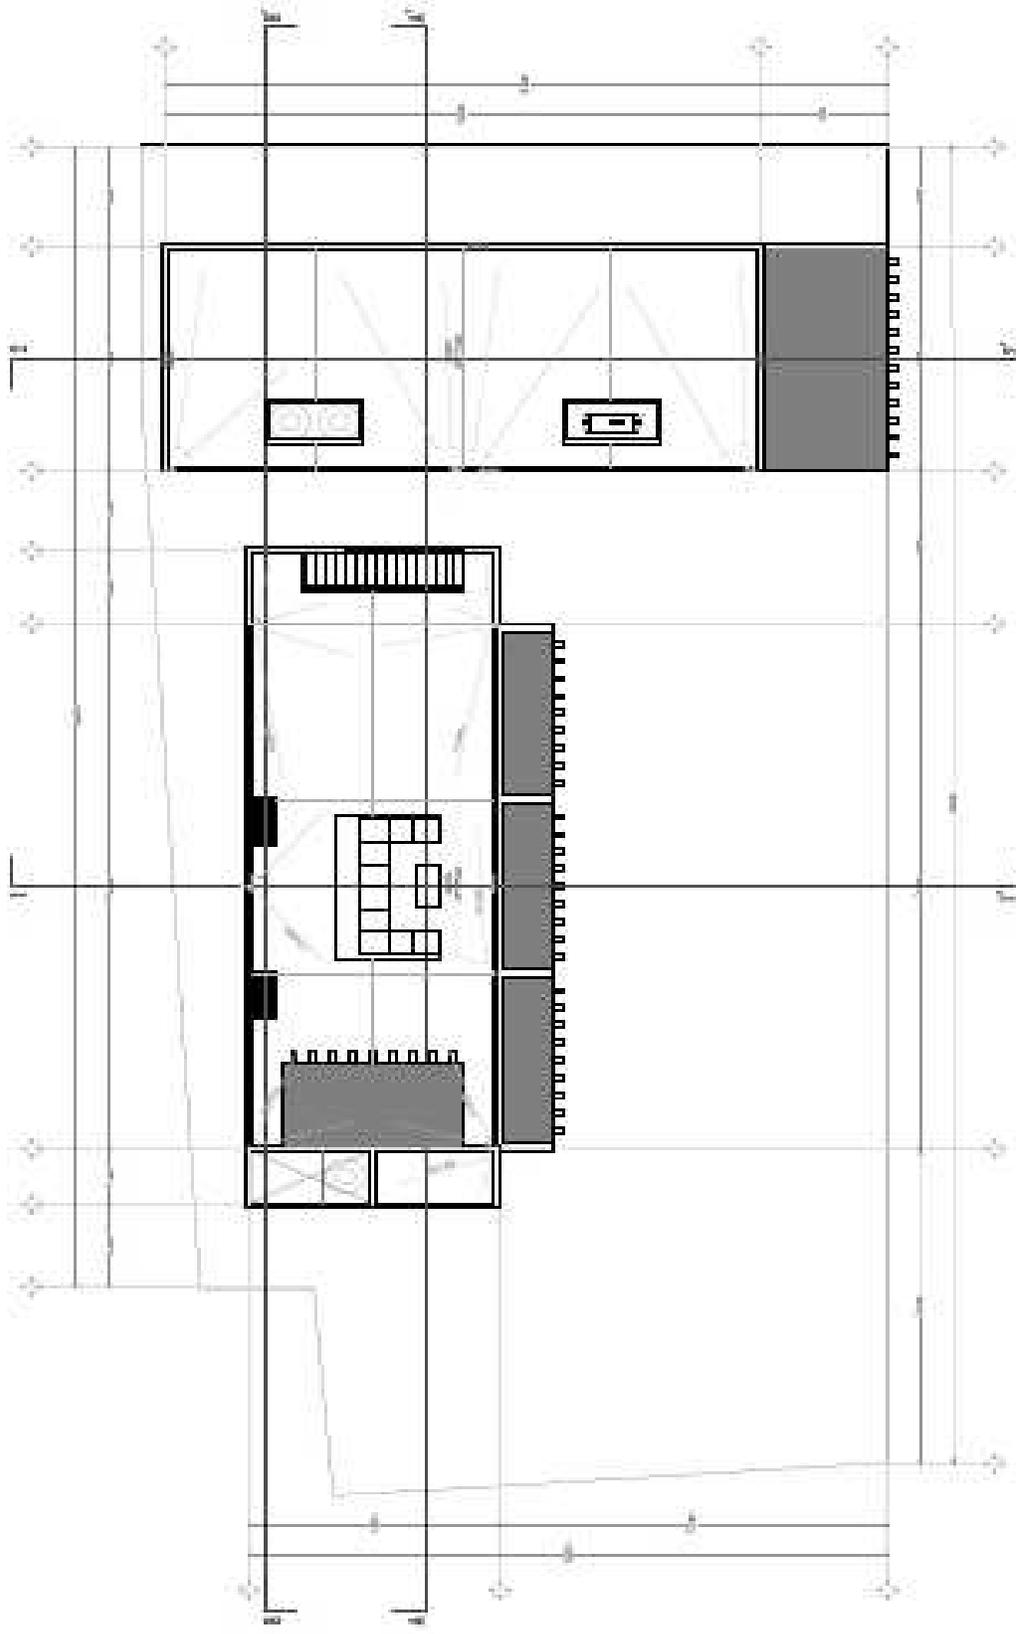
Planta de conjunto, Posada Casa Montiel.
